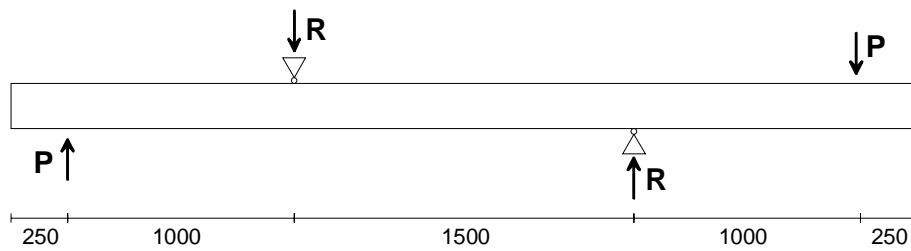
Prøvemner med armeringsarrangement til passive betoner. Alle mål i mm.
